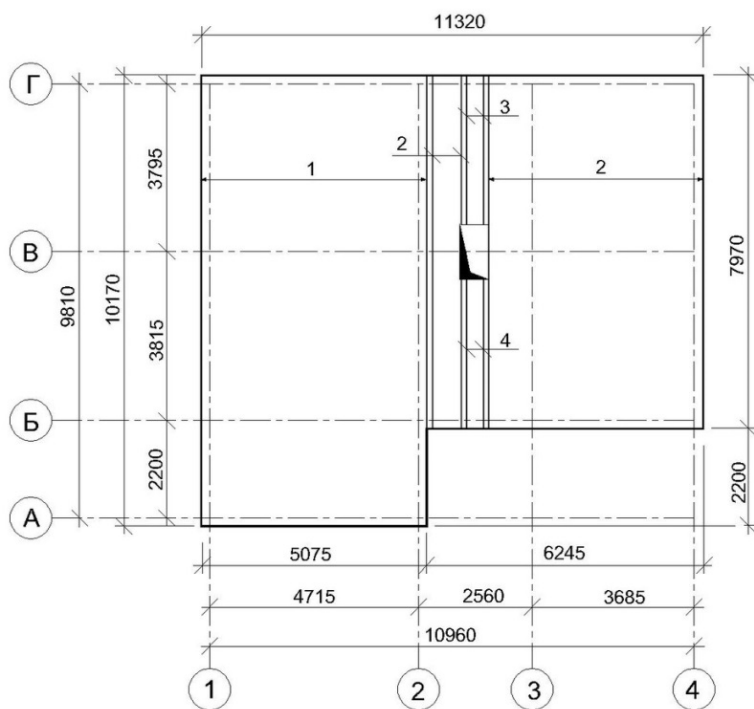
Армирование ППМ на отметке 3.130
